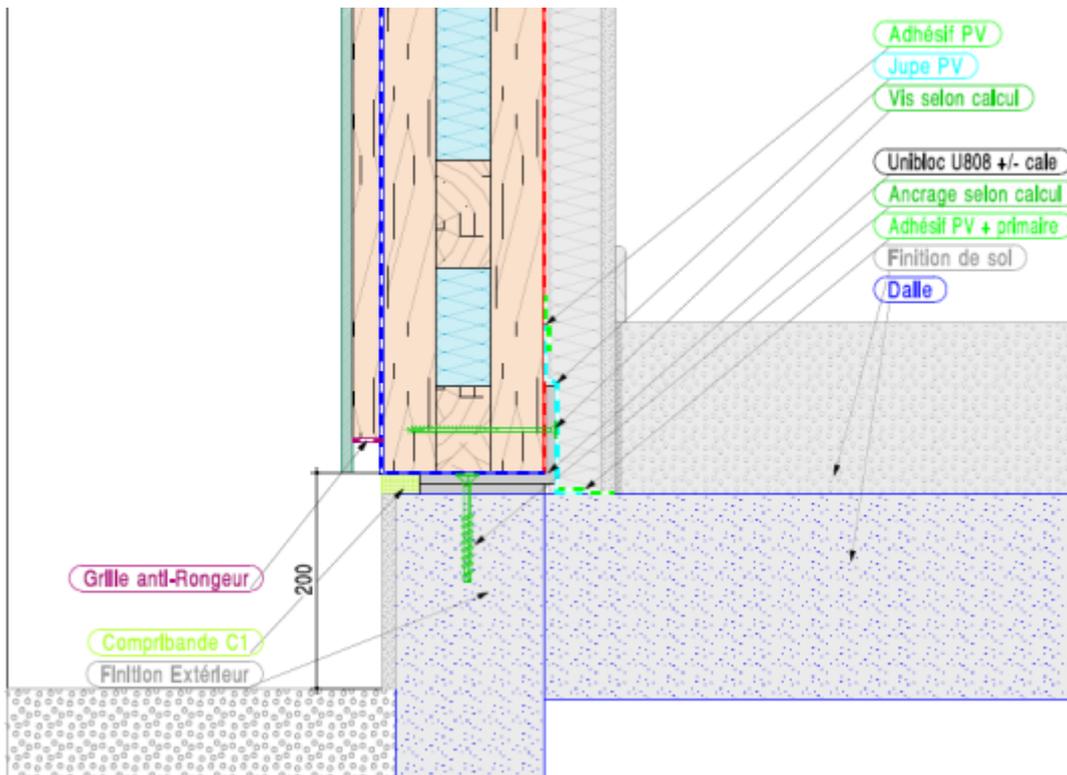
Jonction sur dalle béton en pied de façade / Coupe verticale
